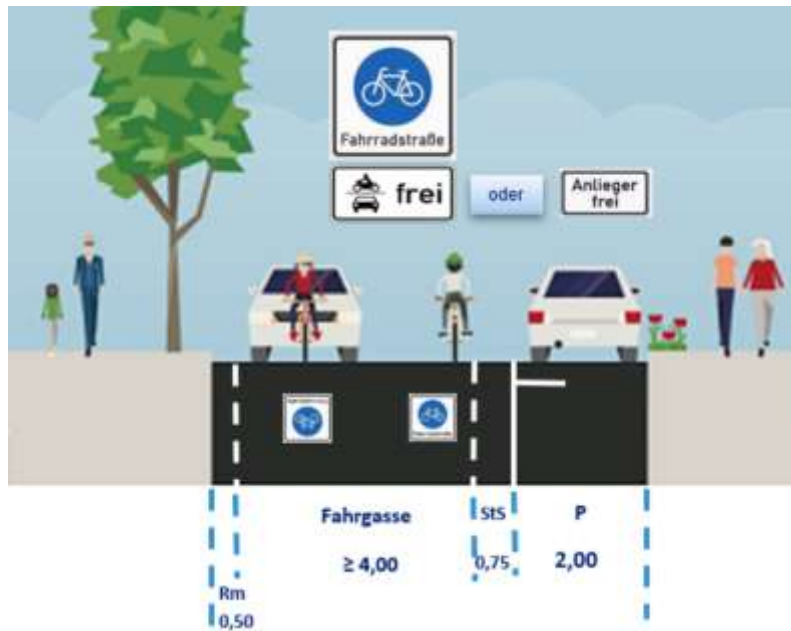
Markierungsstandard für Querschnitte in Fahrradstraßen mit Parkflächen auf einer Fahrbahnseite
